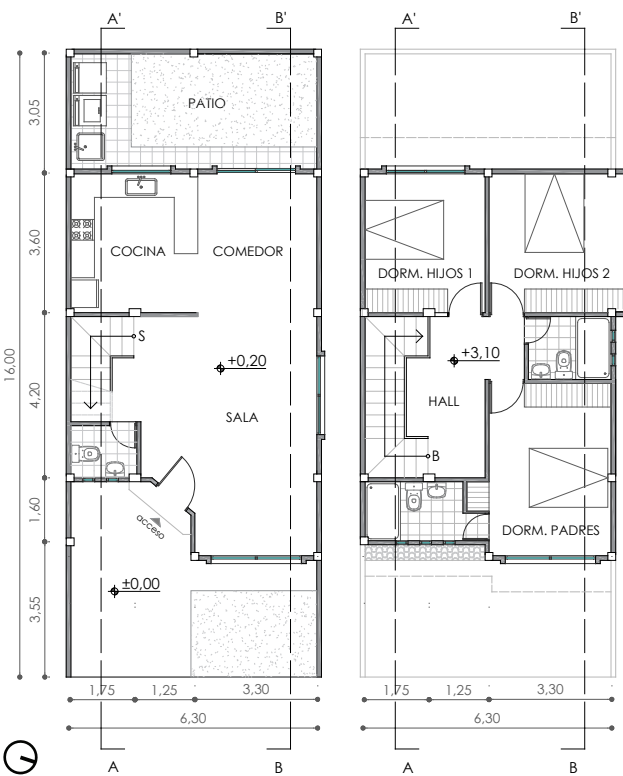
Plantas arquitectónicas vivienda esquinera sureste
